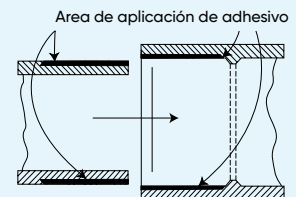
debe aplicarse de forma uniforme capas de adhesivo suficientemente gruesas alrededor de la tubería y dentro del fitting
